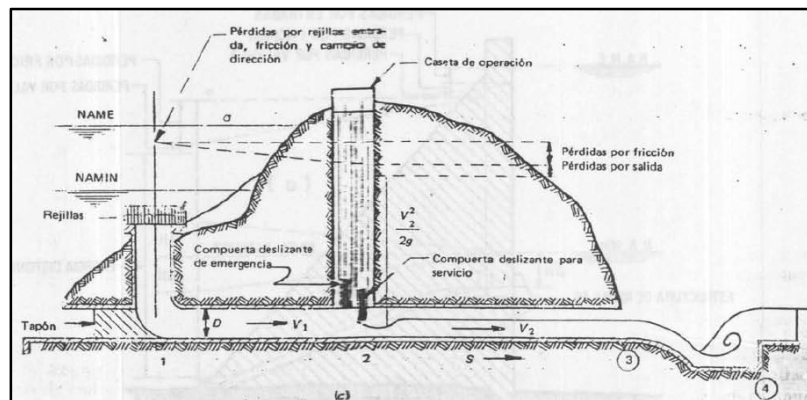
Desfogue de fondo con tiro vertical, túnel a presión galería vertical para compuertas deslizantes y conducto abierto (Torres Herrera, 1983)
